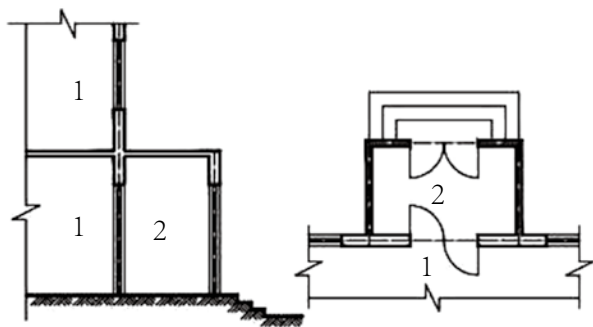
一层平面图(图片来源: <https://www.archdaily.cn>)
